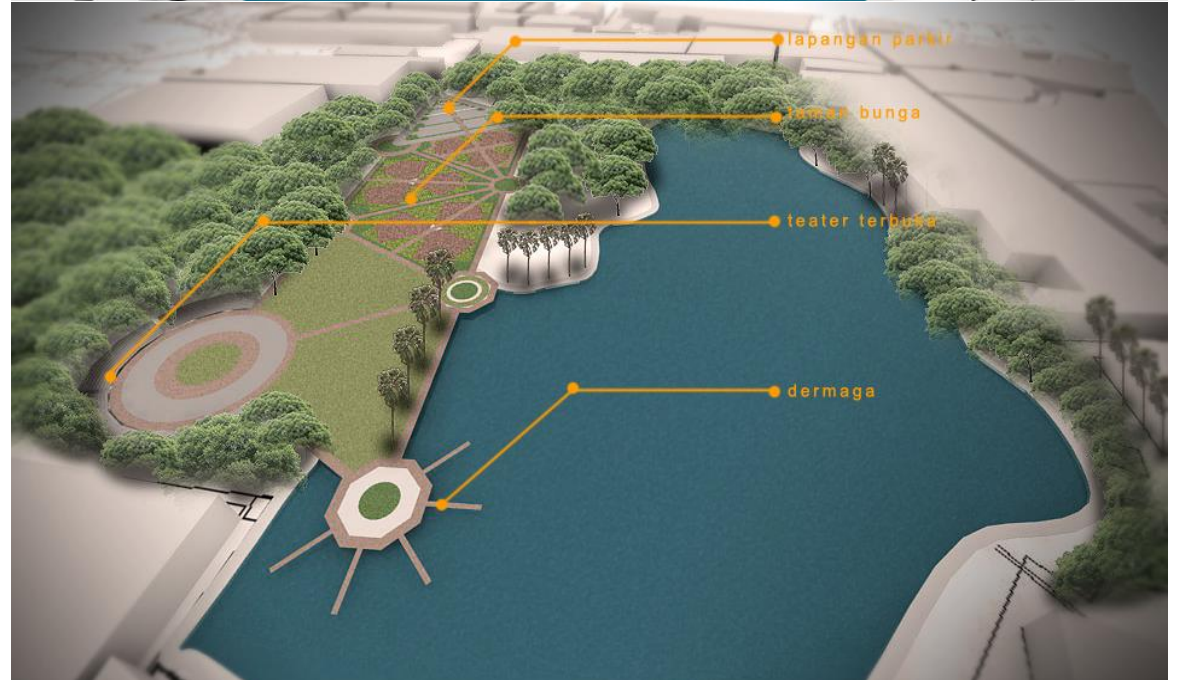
Blok Plan Rencana Penataan Ruang di Kawasan SITU CANGKRING
